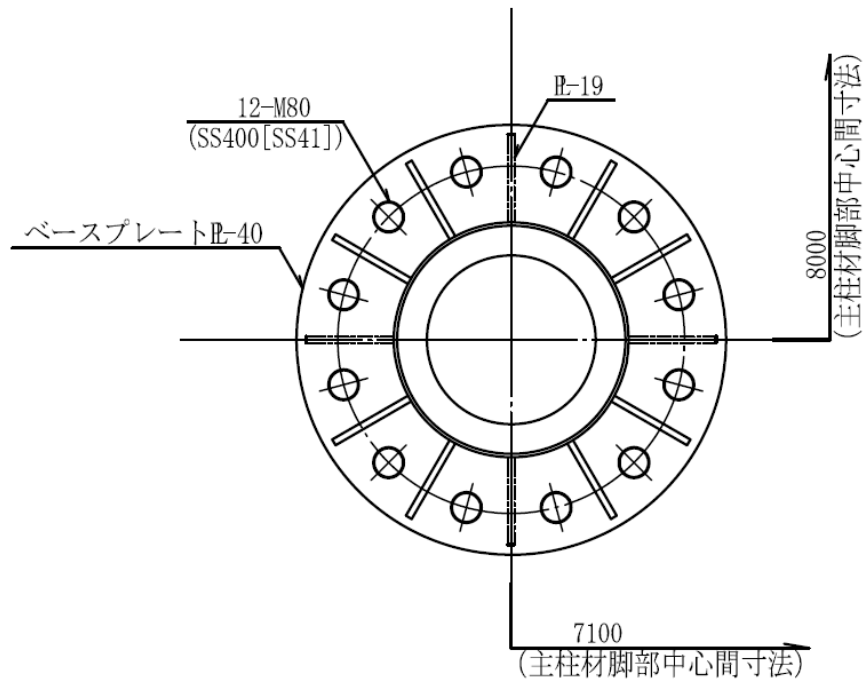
鉄塔部基礎の詳細図 (単位 : mm)
